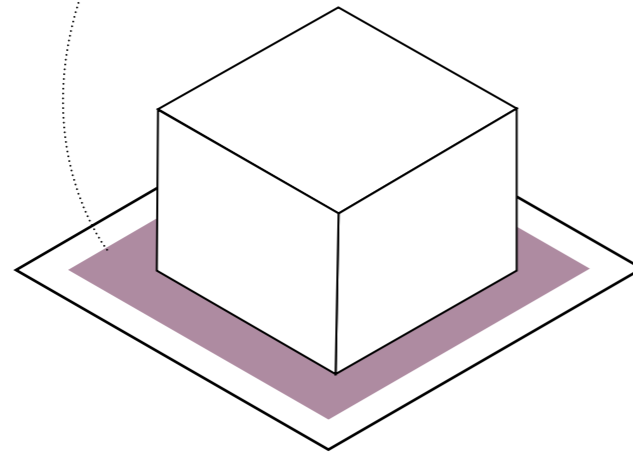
Schematische Darstellung der überbaubaren Fläche
